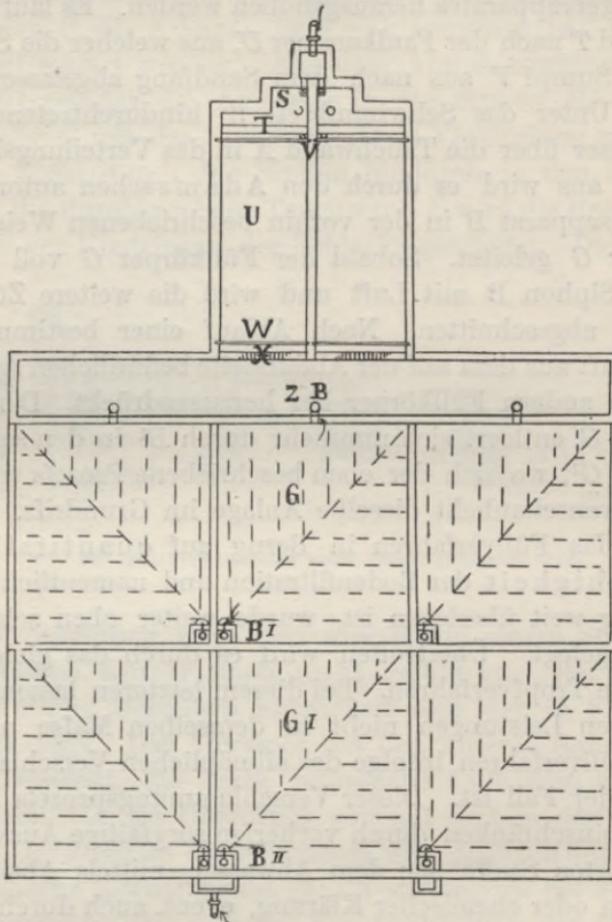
Füllkörperanlage nach Adams (Grundriß).
